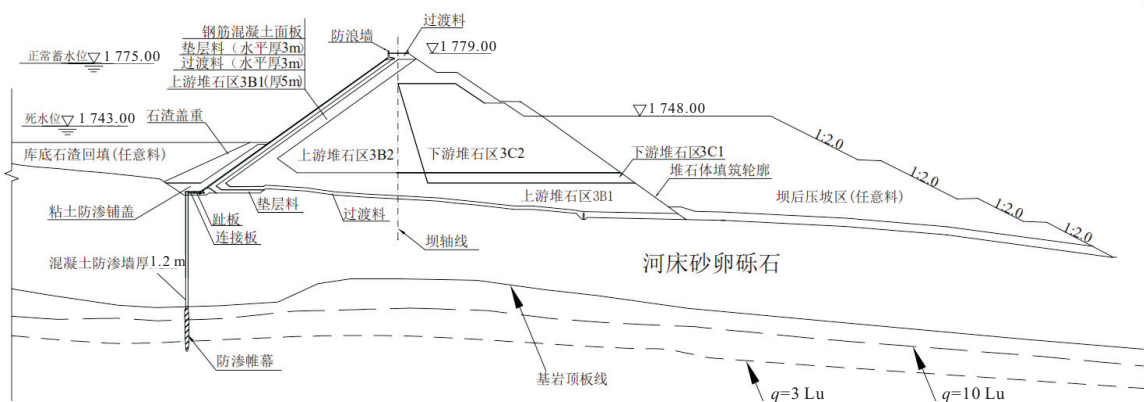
混凝土面板堆石坝典型剖面图(单位:m)
